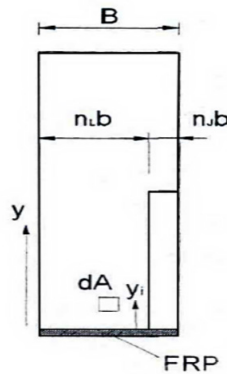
Принципиальная схема поперечного сечения армированной клееной бамбуковой балки
